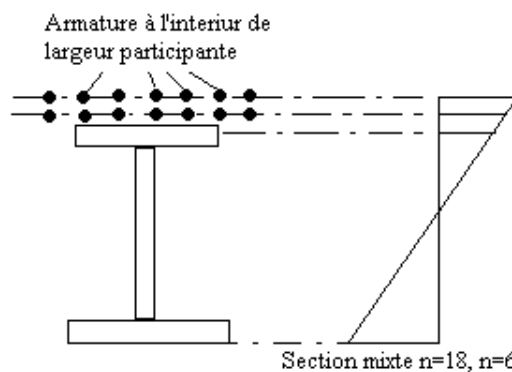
Contraintes dans la section mixte (poutre plus armature passive).
